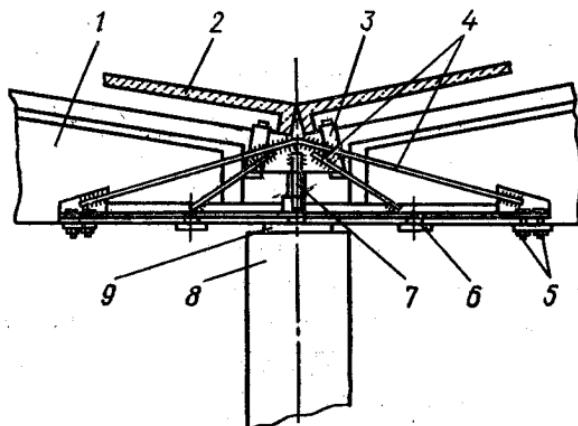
Усиление балки разгружающими кронштейнами:
